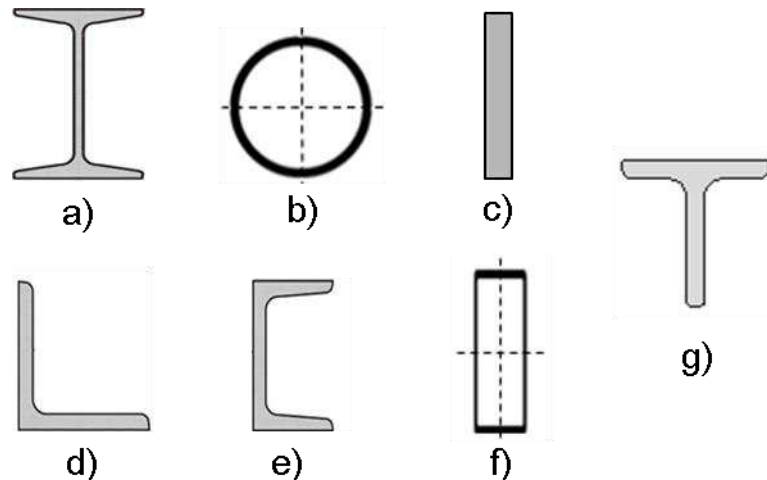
Perfiles estructurales de acero. a) Perfil viga I. b) Perfil tubular circular. c) Perfil rectangular. d) Perfil ángulo. e) Perfil canal. f) Perfil tubular rectangular. g) Perfil T.
